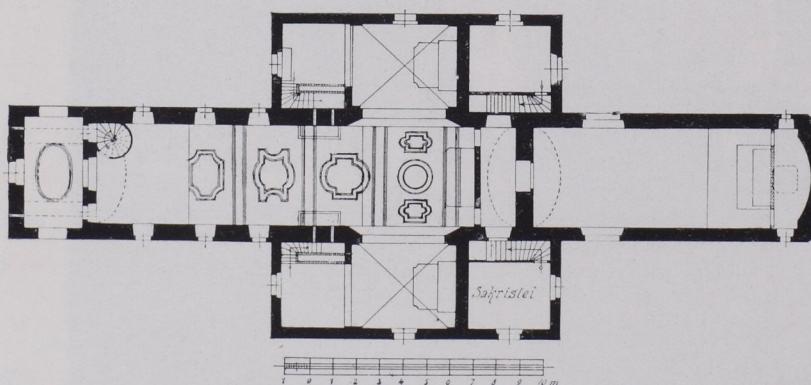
St. Jakob am Thurn, Pfarrkirche und Loretokapelle, Grundriß 1:300 (S. 234).
